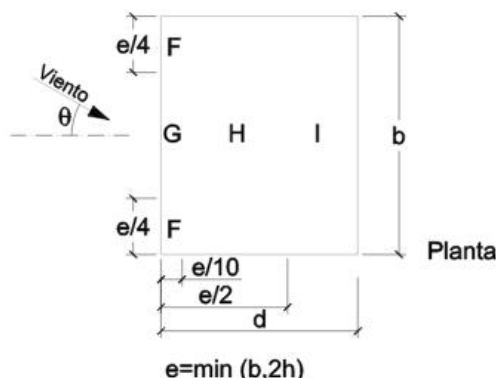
TABLAS CTE CUBIERTA PLANA
